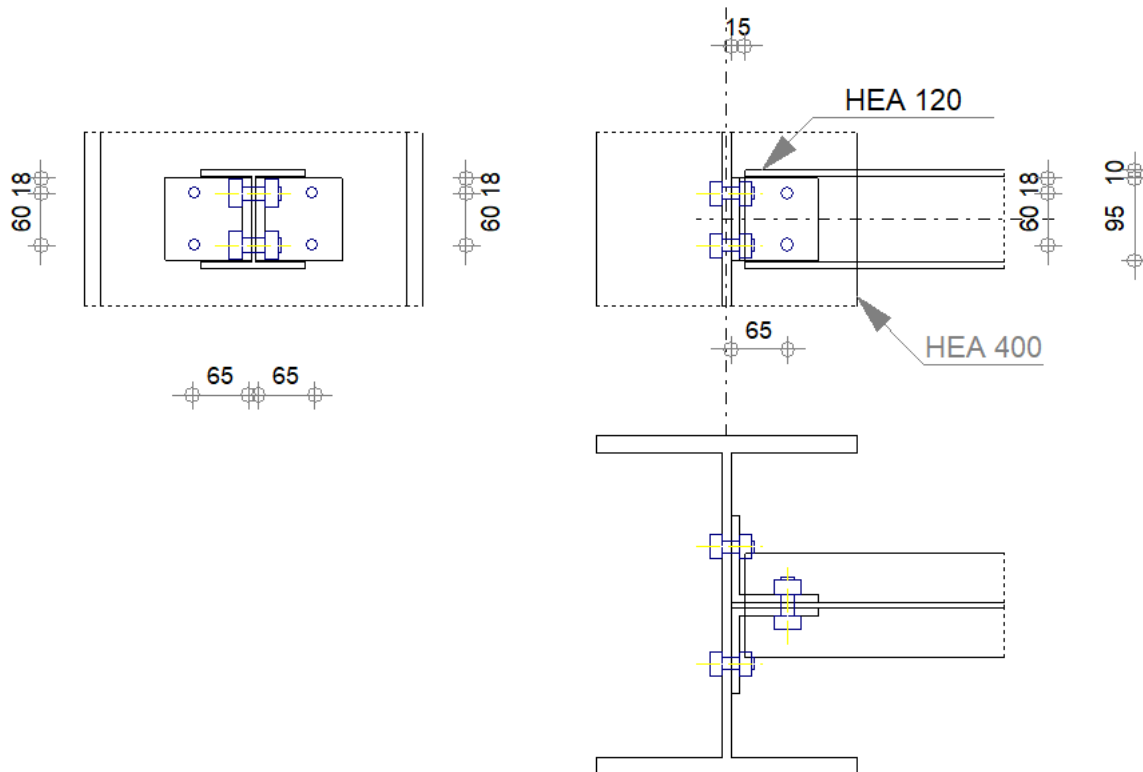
Vue en plan de l'assemblage Poteau-Poutre sablière(HEA120).
